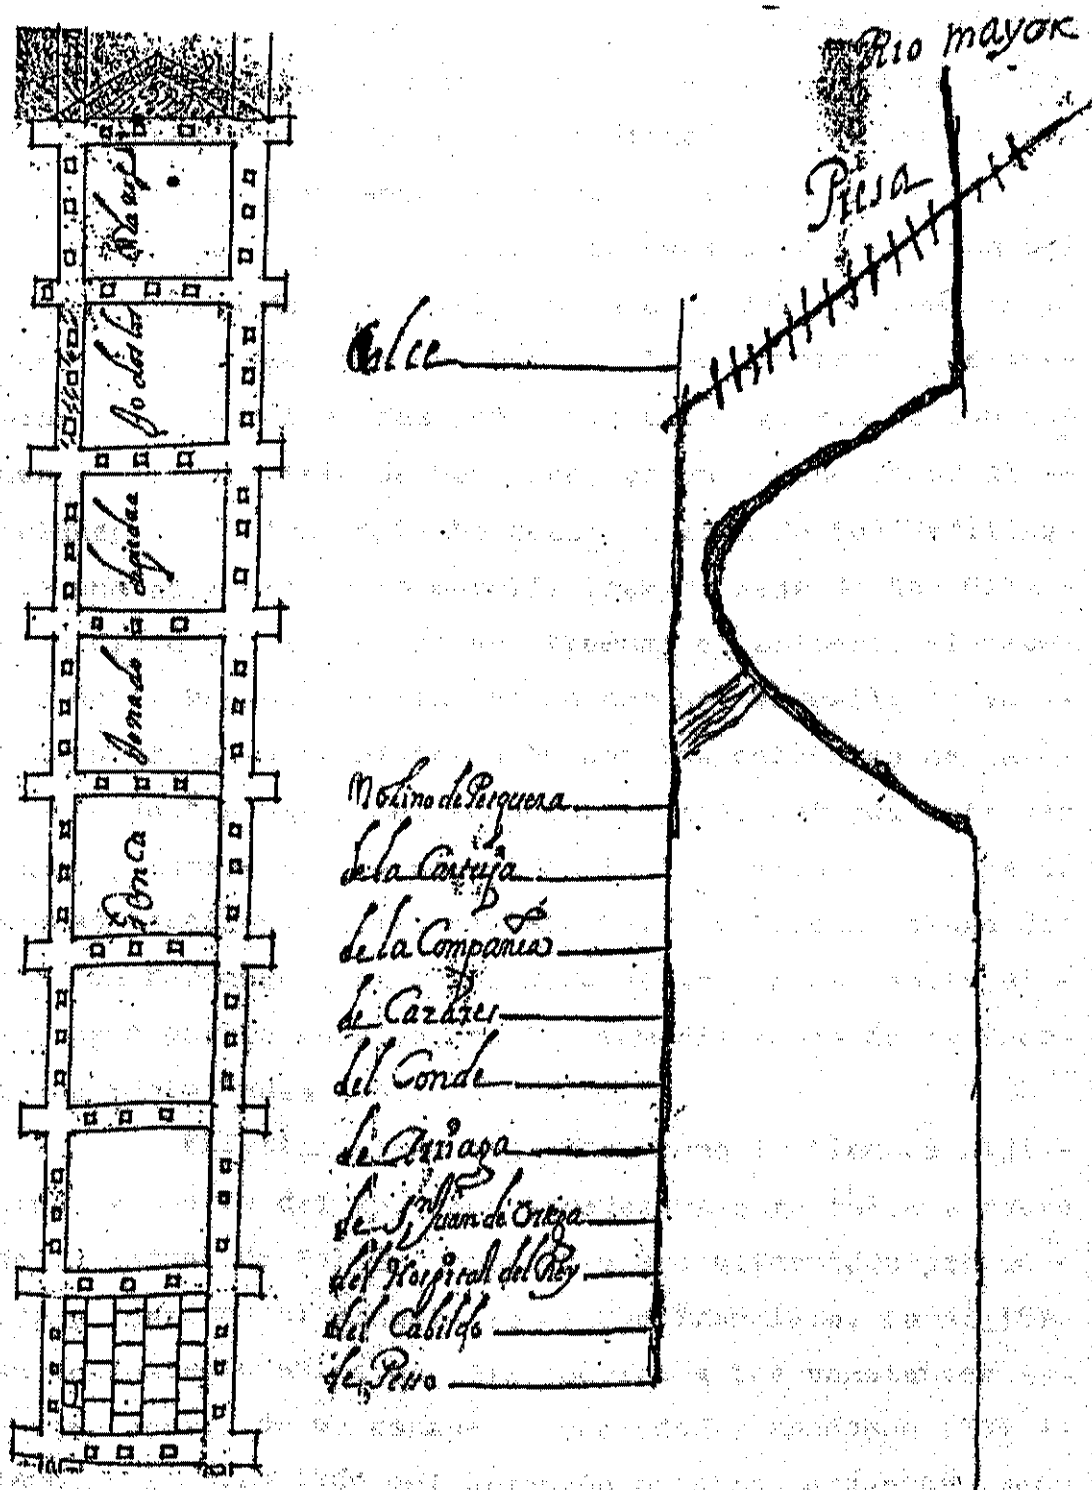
Planta para la construcción de una presa en el rio Arlanzón. Año 1691.
